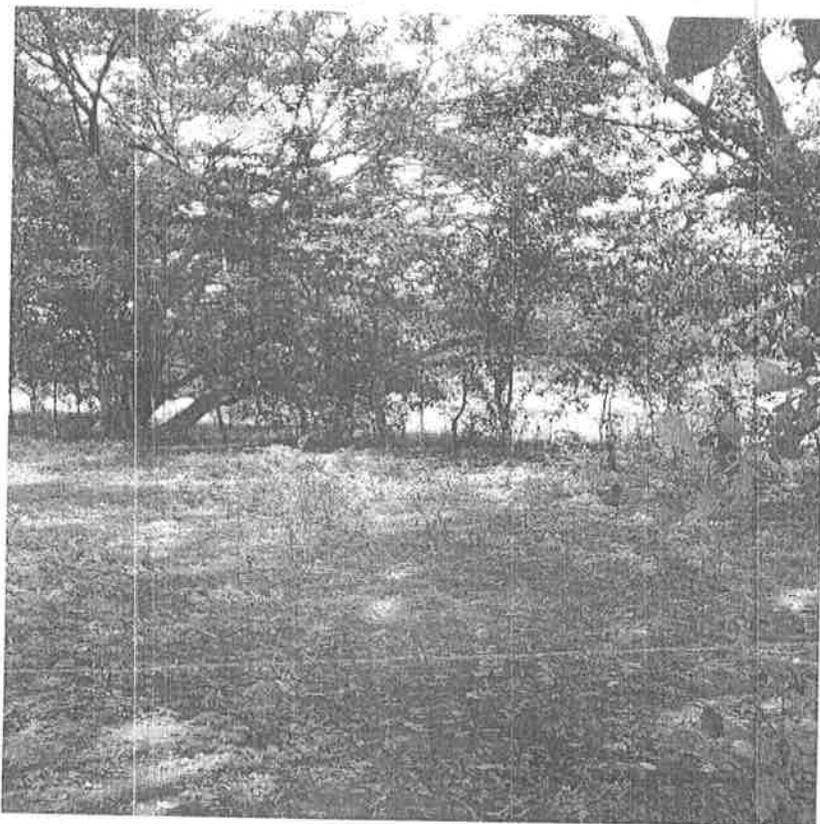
Área de posible construcción de acceso a las zonas 11,12, 13,14
